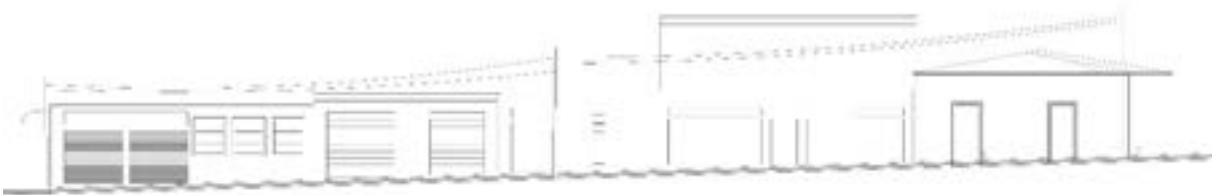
Extracción de formas 1ra avenida Fachada Oeste
